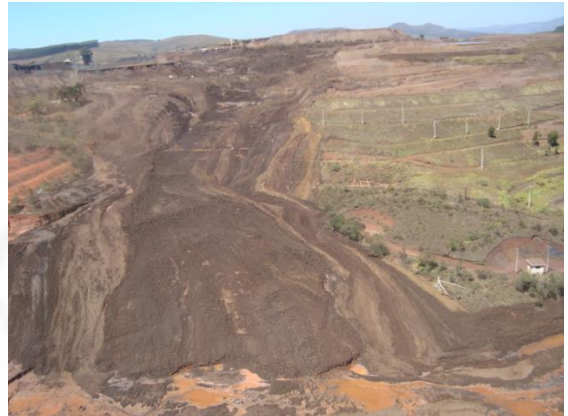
Vista de frente do movimento de massa proveniente do colapso da B1.
